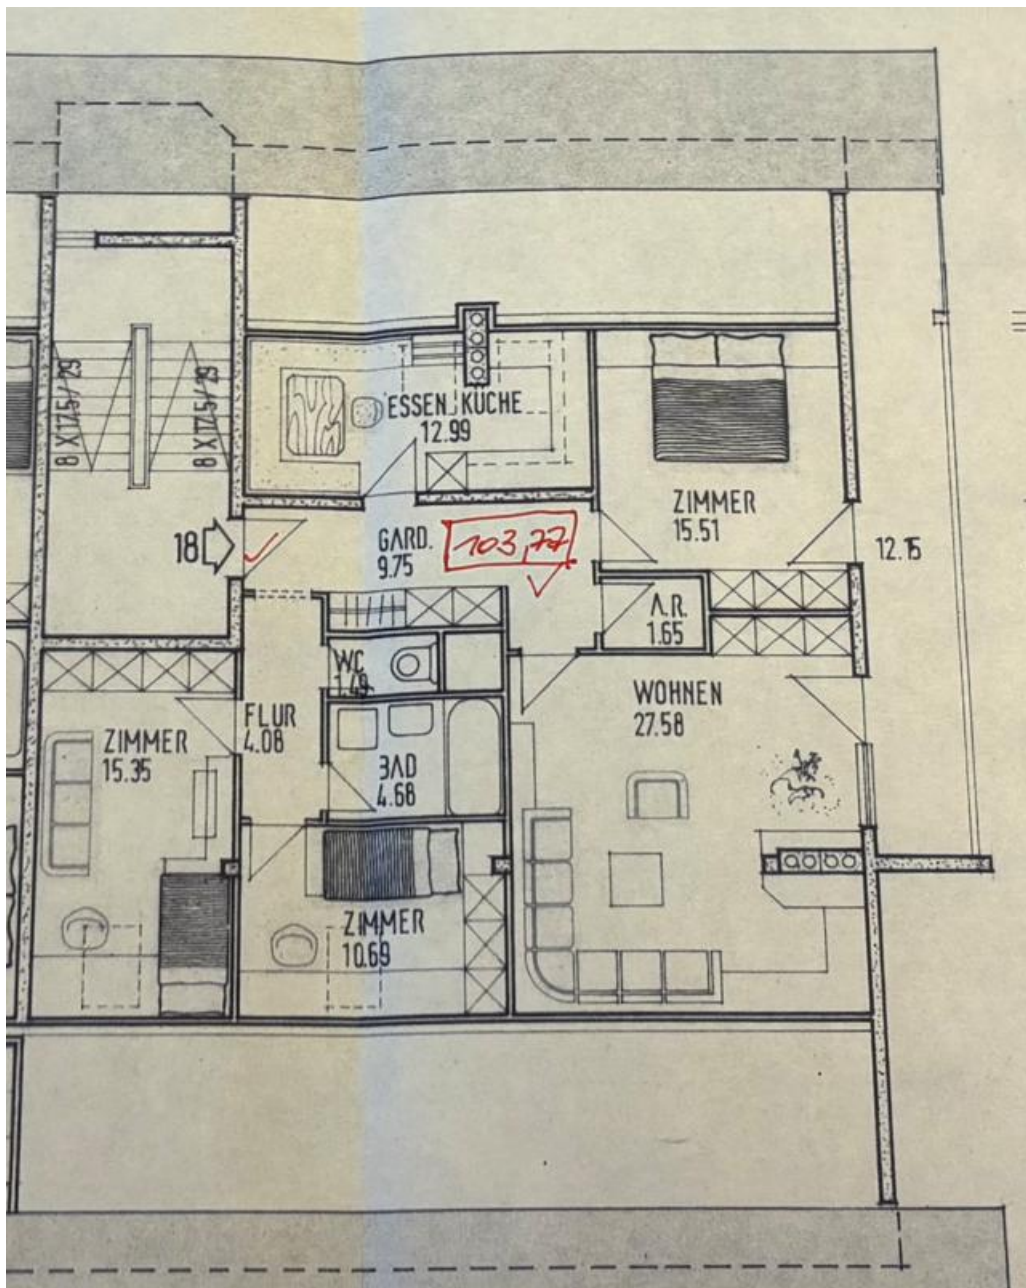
Grundriss Wohnung Top W 18 gem. Tekturplan vom August 1979
